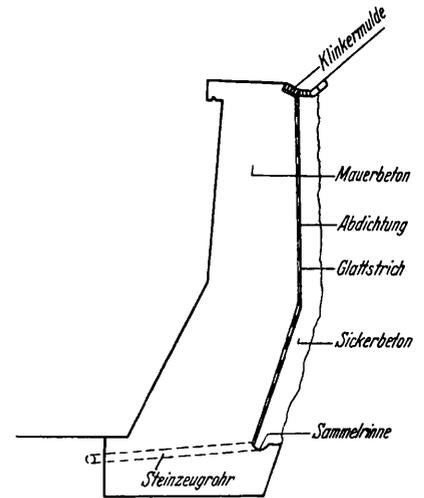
Stützmauer mit Abdichtung und Sickerbeton-Entwässerung.
